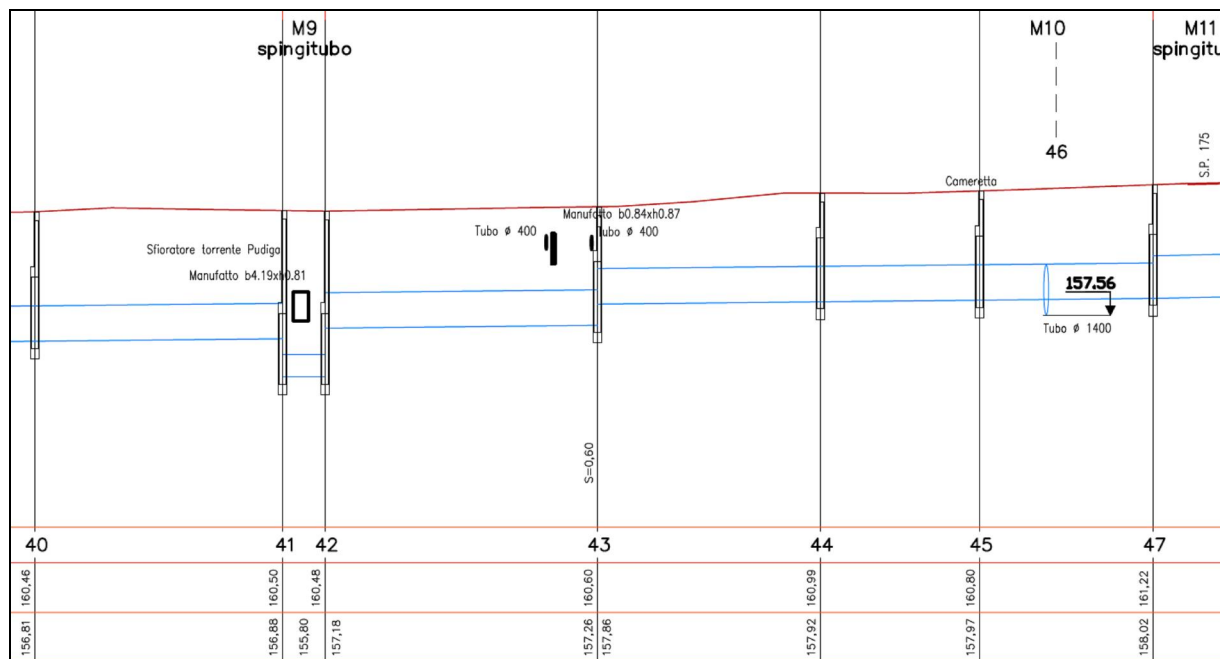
profilo longitudinale di progetto del collettore consortile da realizzare (fonte: Ianomi S.p.A.)
